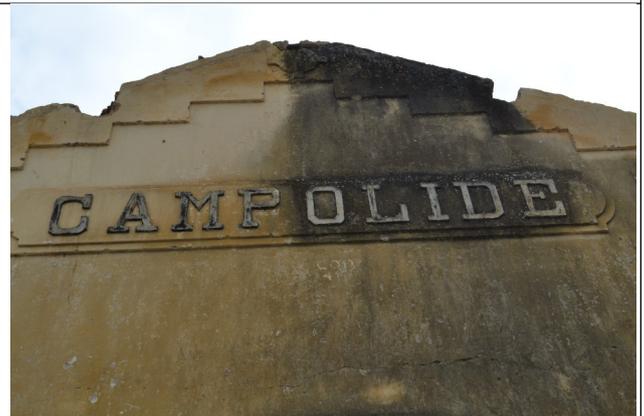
e 04 – Fachadas da estação ferroviária que se apresenta sem a cobertura.
